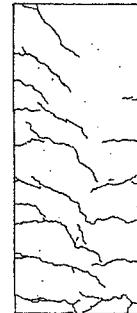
ひび割れ進行状況(H4-2, 20mm)
